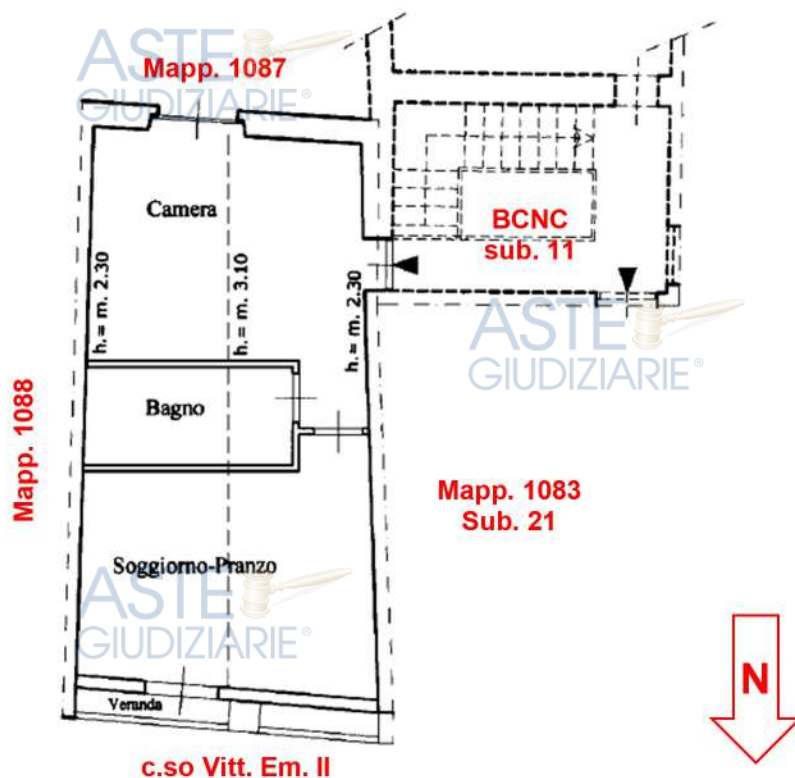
LOTTO 8. Planimetria catastale (fuori scala). Nord in basso
